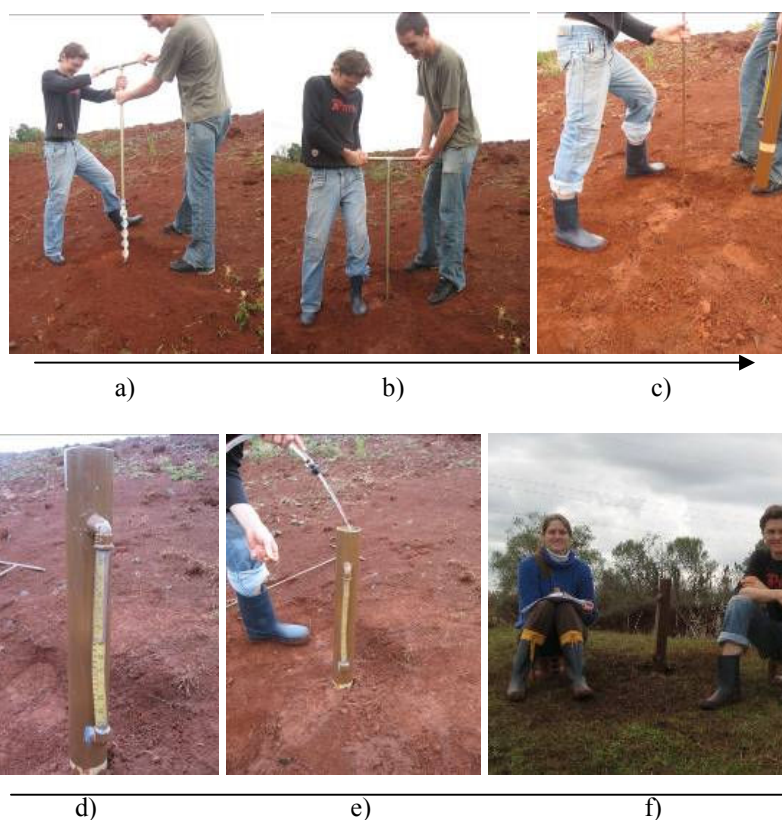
Seqüência de execução do ensaio em furo de sondagem – a) preparação do local; b) realização do furo; c) escarificação do furo; d) colocação do tubo acoplador; e) enchimento com água; f) leitura e anotações na planilha.
